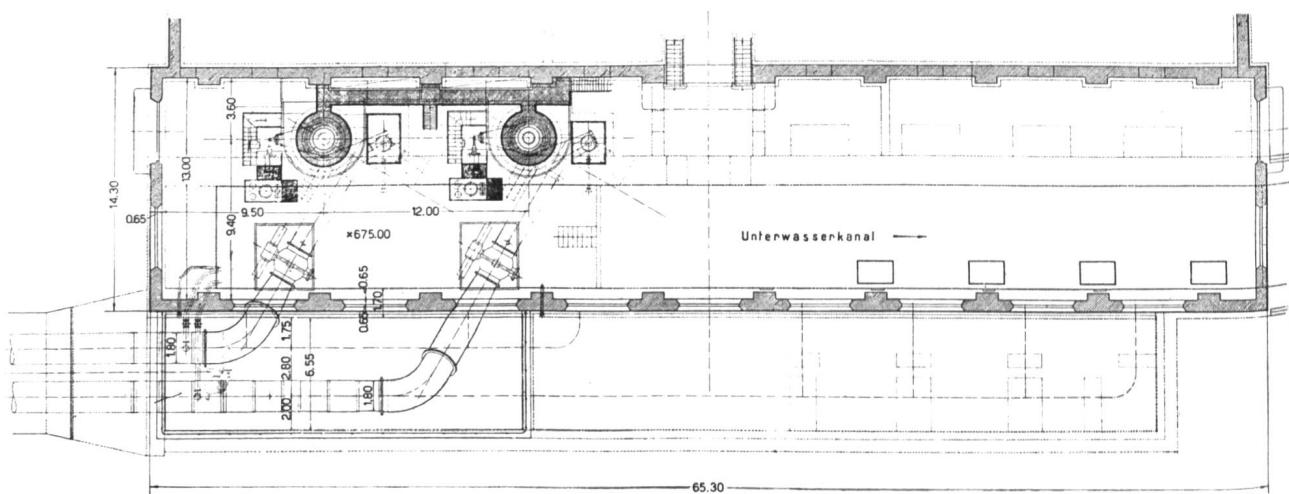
Grundriss des umgebauten Maschinenhauses des Kraftwerkes Albula der Stadt Zürich (Umbauprojekt 1943). Maßstab 1:500.
